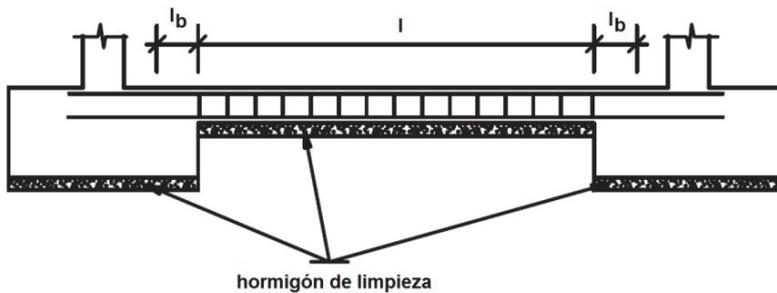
Hormigón de limpieza bajo zapatas arriostradas
